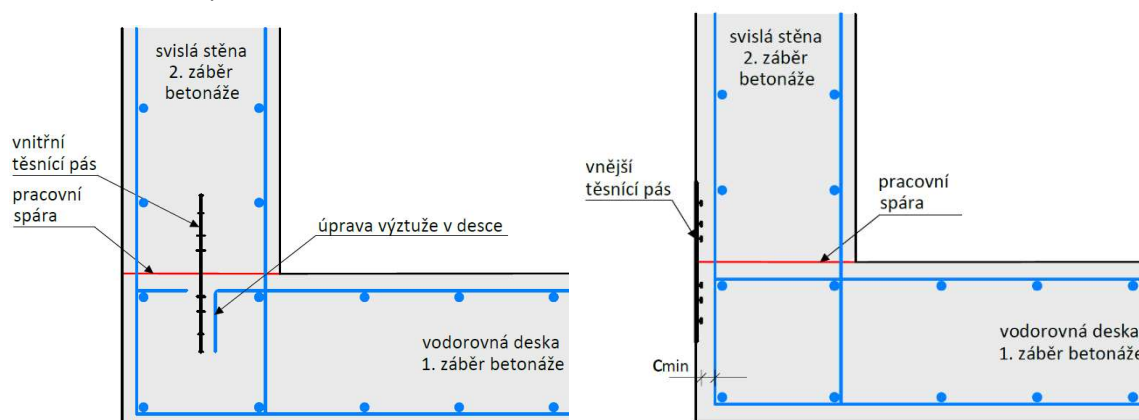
(vpravo): Detail napojení bitumenových těsnicích plechů (styk deska/stěna) Zdroj: autor BP
